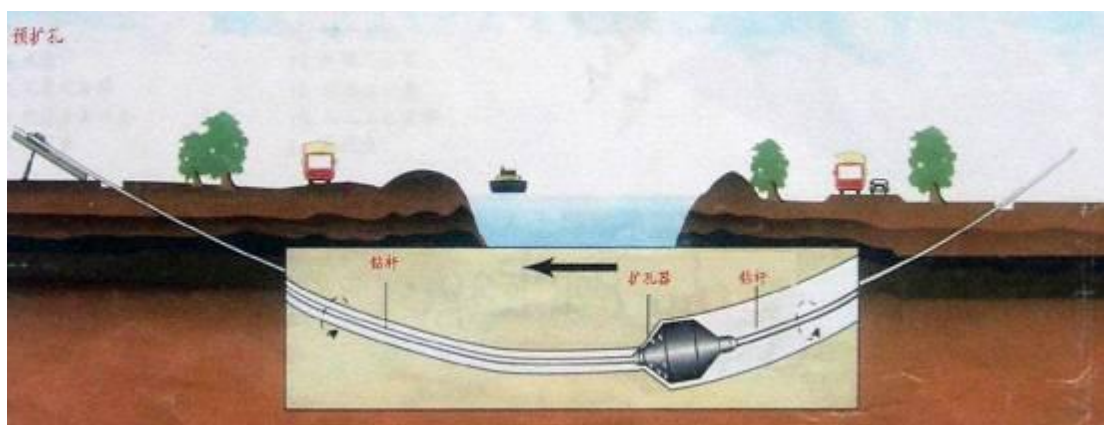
定向钻穿越施工预扩孔过程断面示意图
